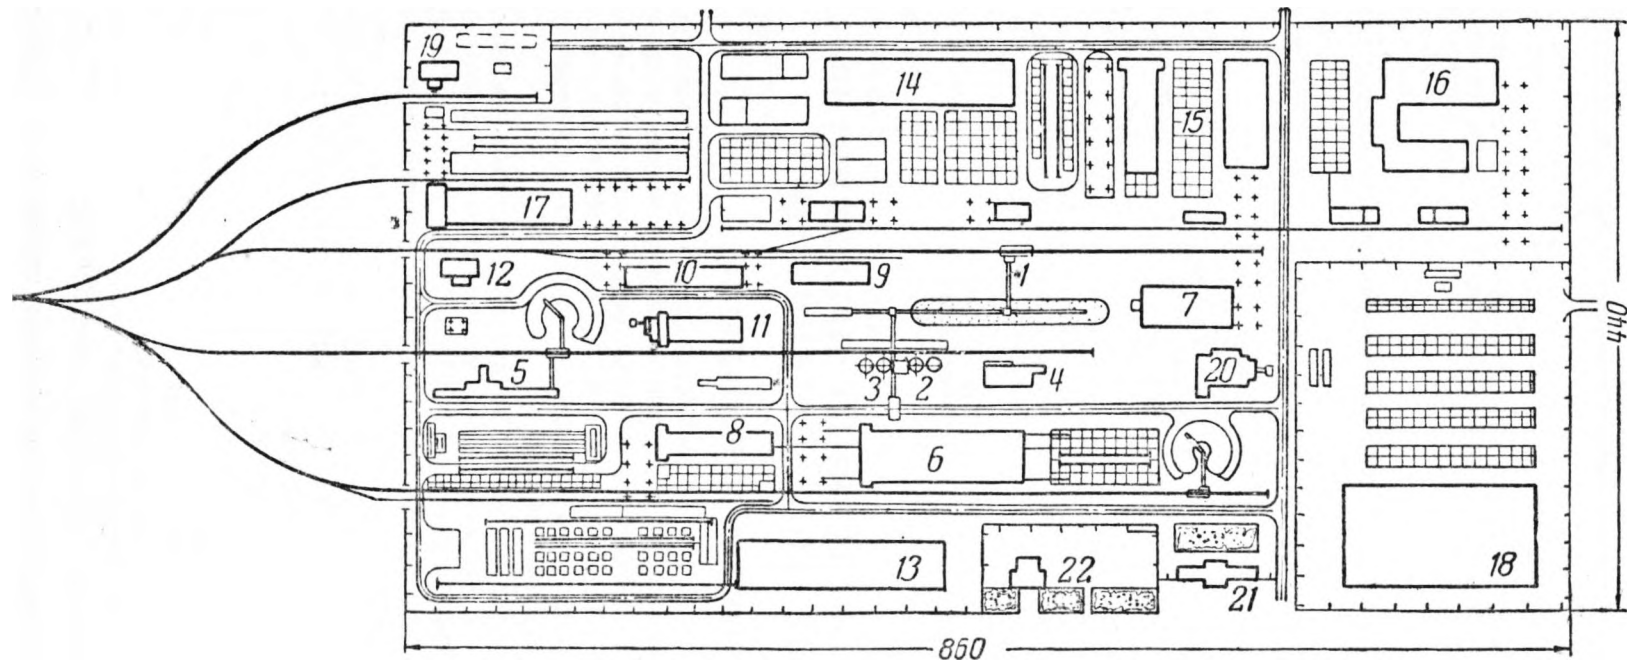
Схема генерального плана производственной базы строительно-монтажного треста с годовым объемом 200—300 млн. руб.
